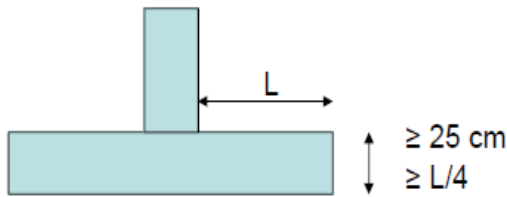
Simetrik betonarme tekil temellerde kesit ve donatı
